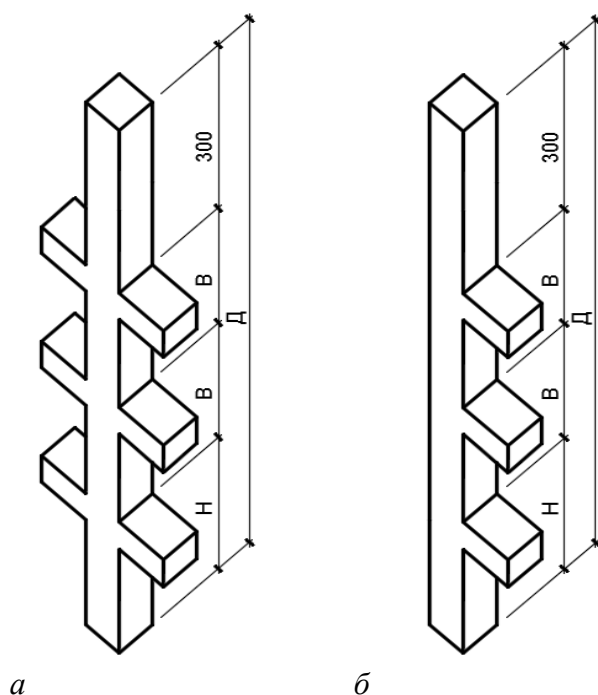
Колонны железобетонные с консолями (на два этажа):
